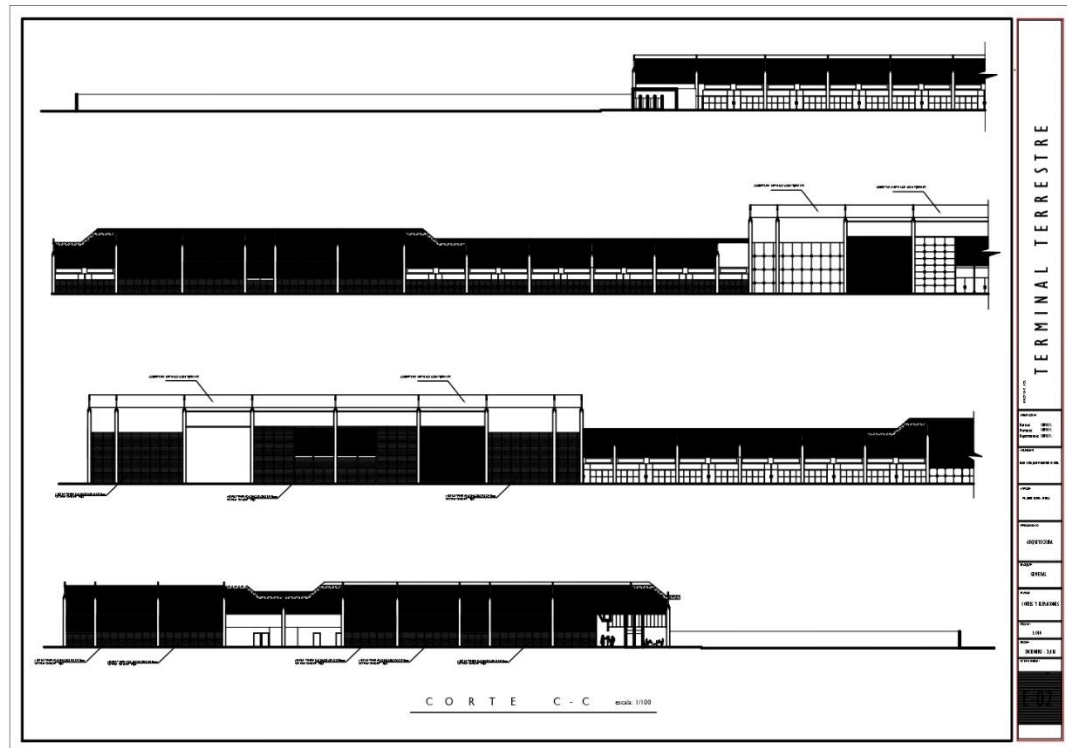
Corte y elevaciones: Corte C – C. Elaboración Propia
